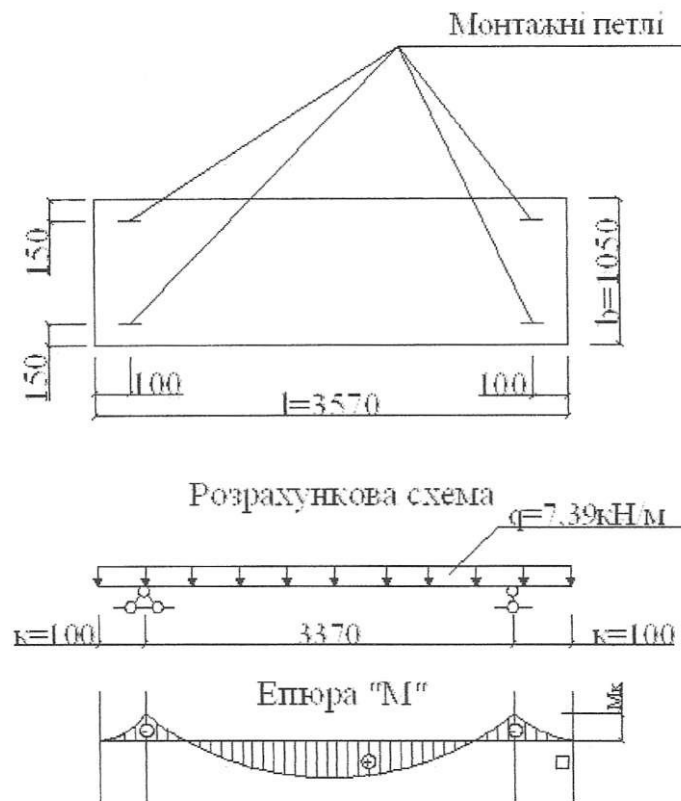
Розрахункова схема сходового маршу на транспортні зусилля.
